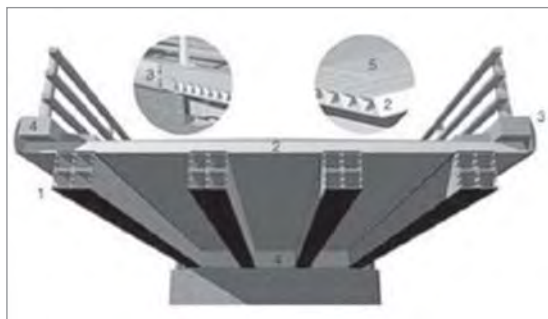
Ponte West Mill, Inglaterra, 2002: (1) vigas pultrudadas; (2) laje moldada (FIBERLINE COMPOSITES)
